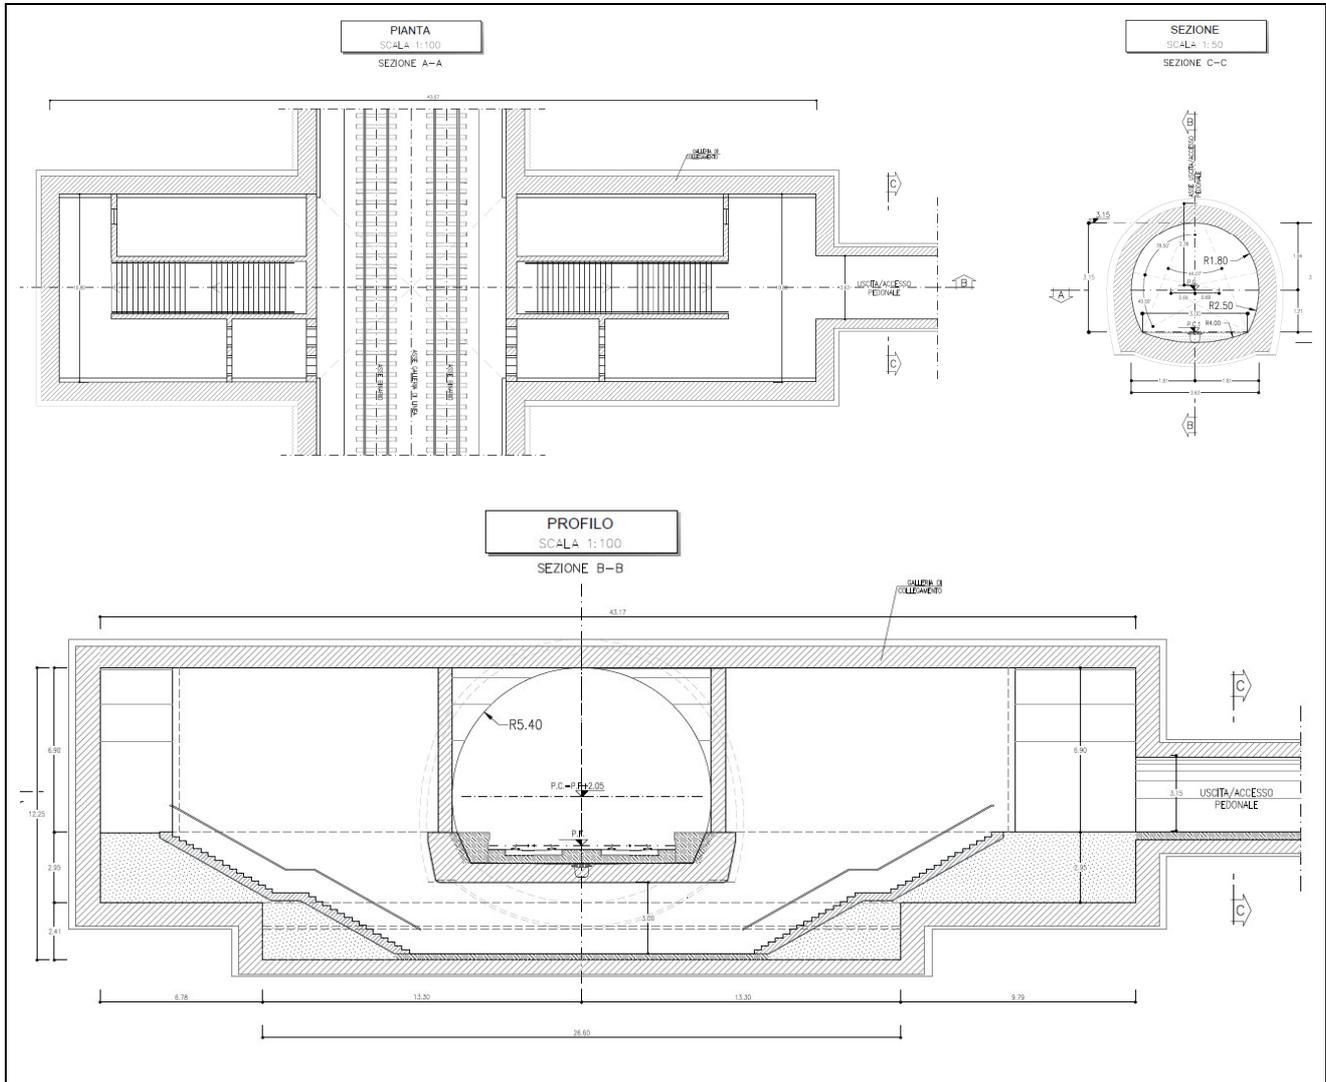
Uscite di sicurezza gallerie La Rossa II e Murano – Pianta, sezione e profilo
